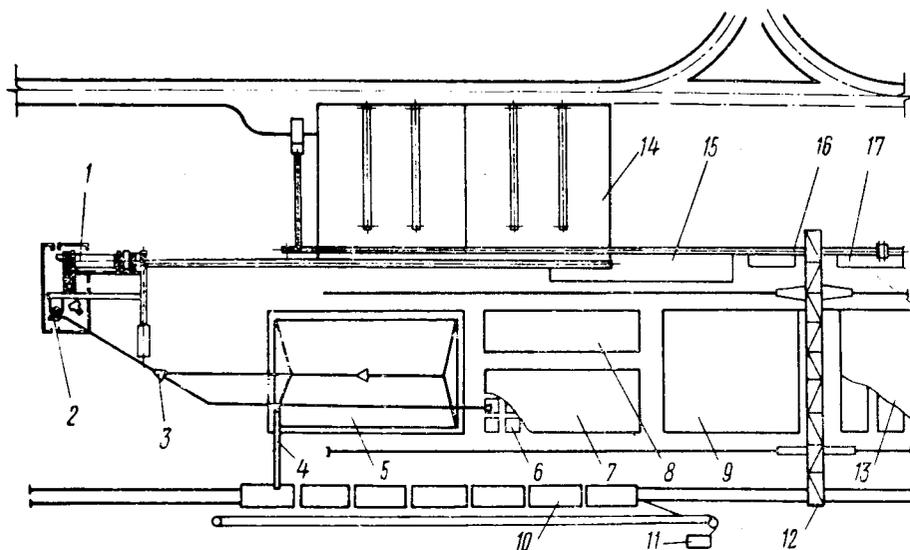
Схема размещения площадки открытого хранения щепы на нижнем складе, оснащенном контейнерами:
